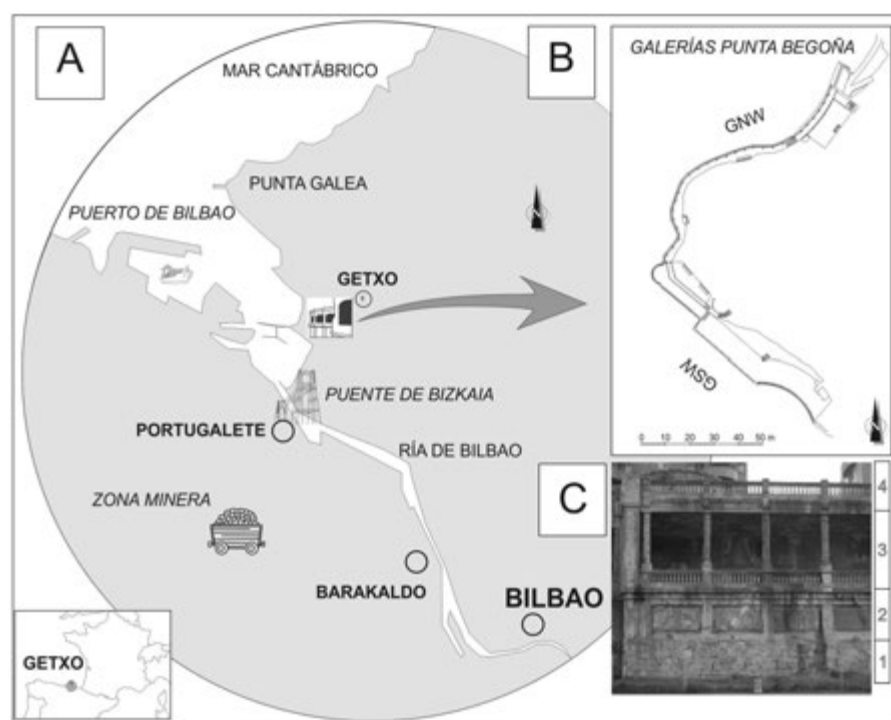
A) Localización geográfica de las Galerías Punta Begoña. B) Planta de las Galerías Punta Begoña (GNW: Galería noroeste; GSW: Galería suroeste). C) Sector central de la fachada de la GSW. (1: muro de mampostería de arenisca; 2: tramo de hormigón; 3: galería/corredor; 4: jardín superior). Ver figura en color en la web.
